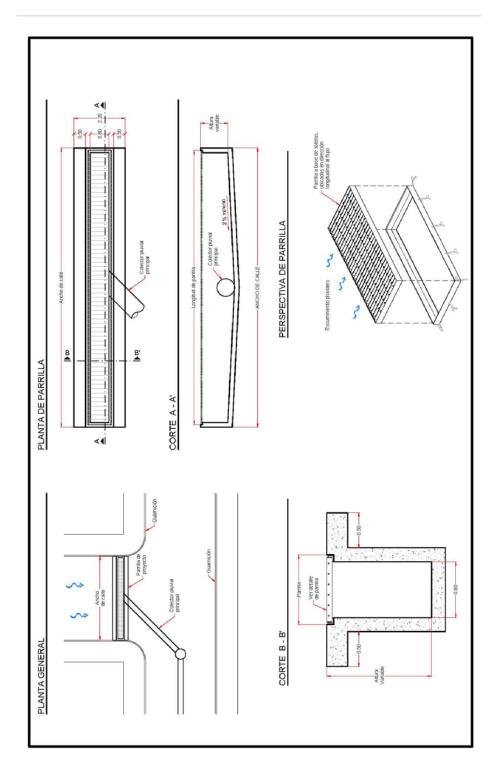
Detalles de obra de captación con parrillas.
